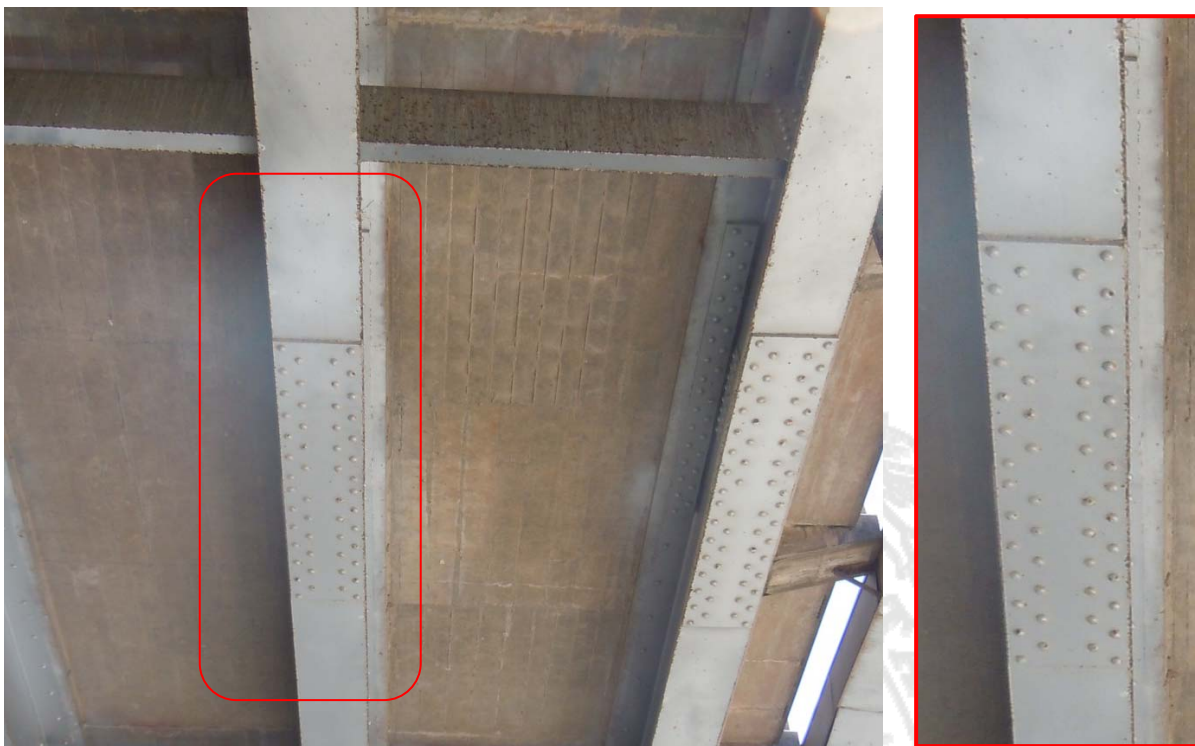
Oxidación en los bordes de las vigas principales de acero.
